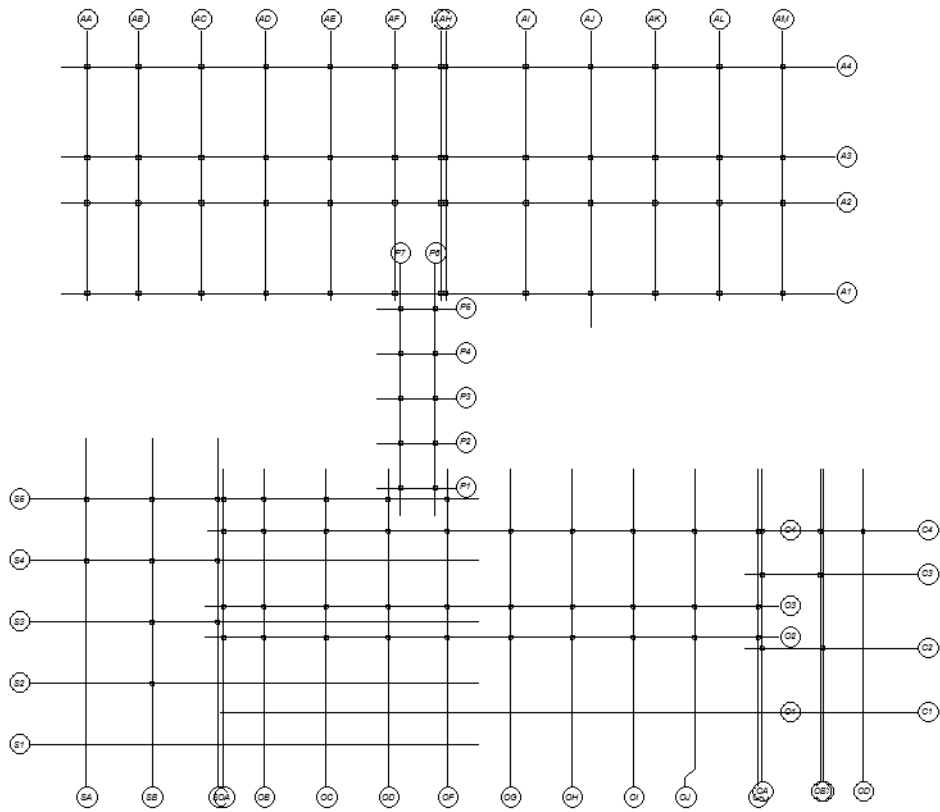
Rejillas con Pilares estructurales sobre ellas
